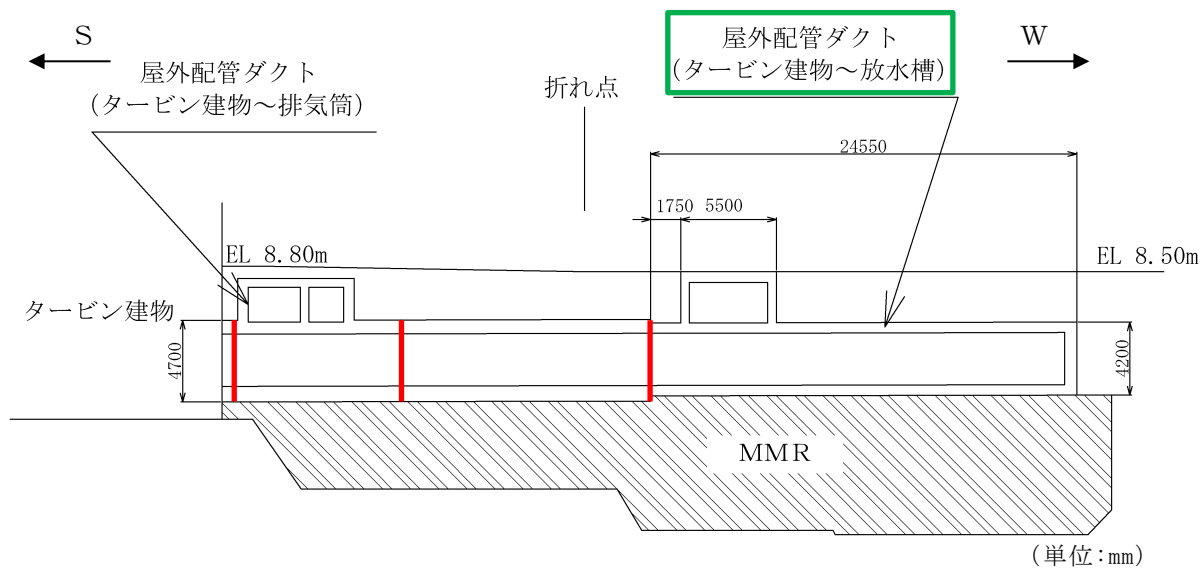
屋外配管ダクト (タービン建物～放水槽) 断面図 (D-D断面)
